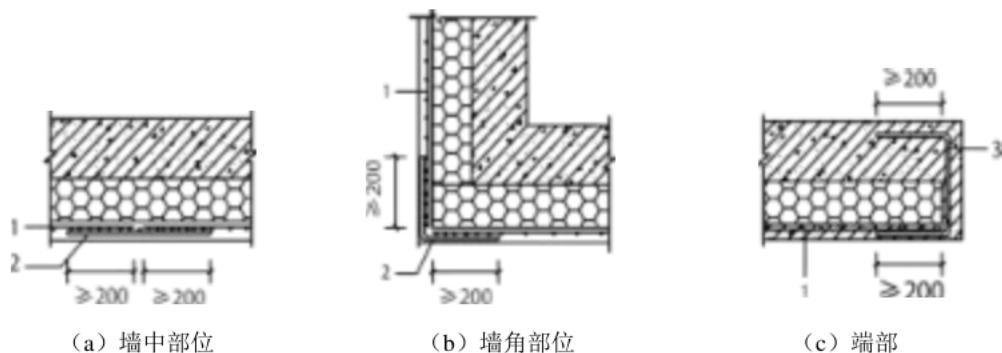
防护层钢筋焊接网水平搭接
